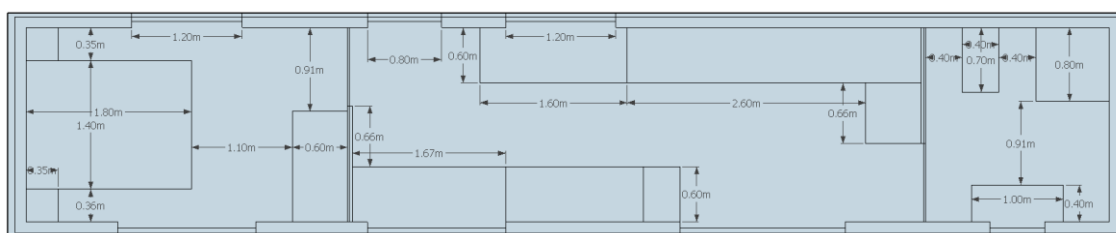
Planta base para teste de cenários do Projeto 1.
